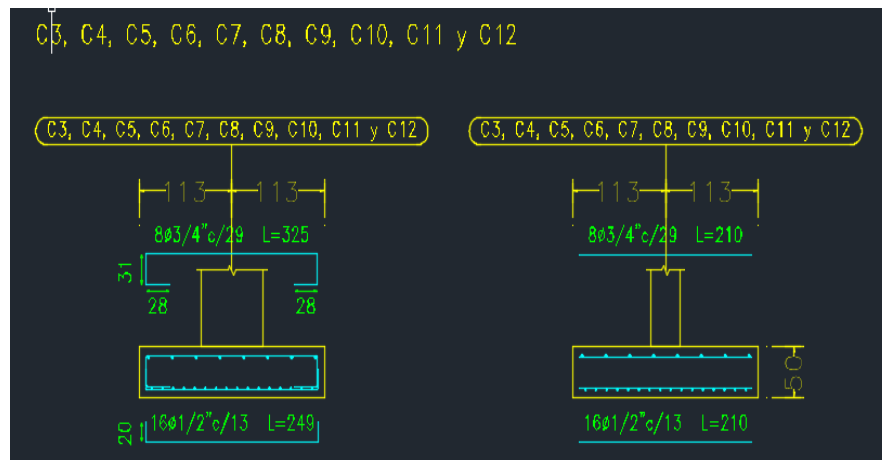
Vista en planta Zapata tipo II. Fuente: planos estructurales
